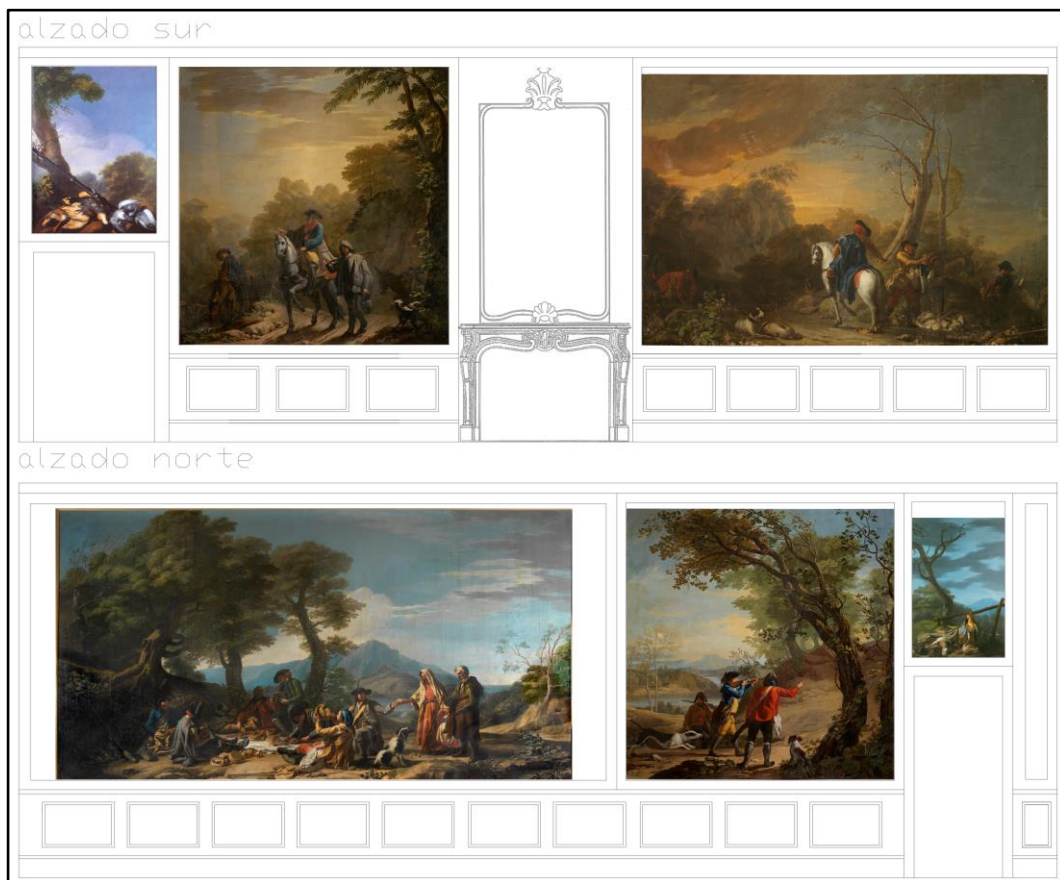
Reconstrucción de los alzados norte y sur de la Pieza de Cámara, según los autores (alzados realizados por Diego Ruiz-Vernacci Lozano).
